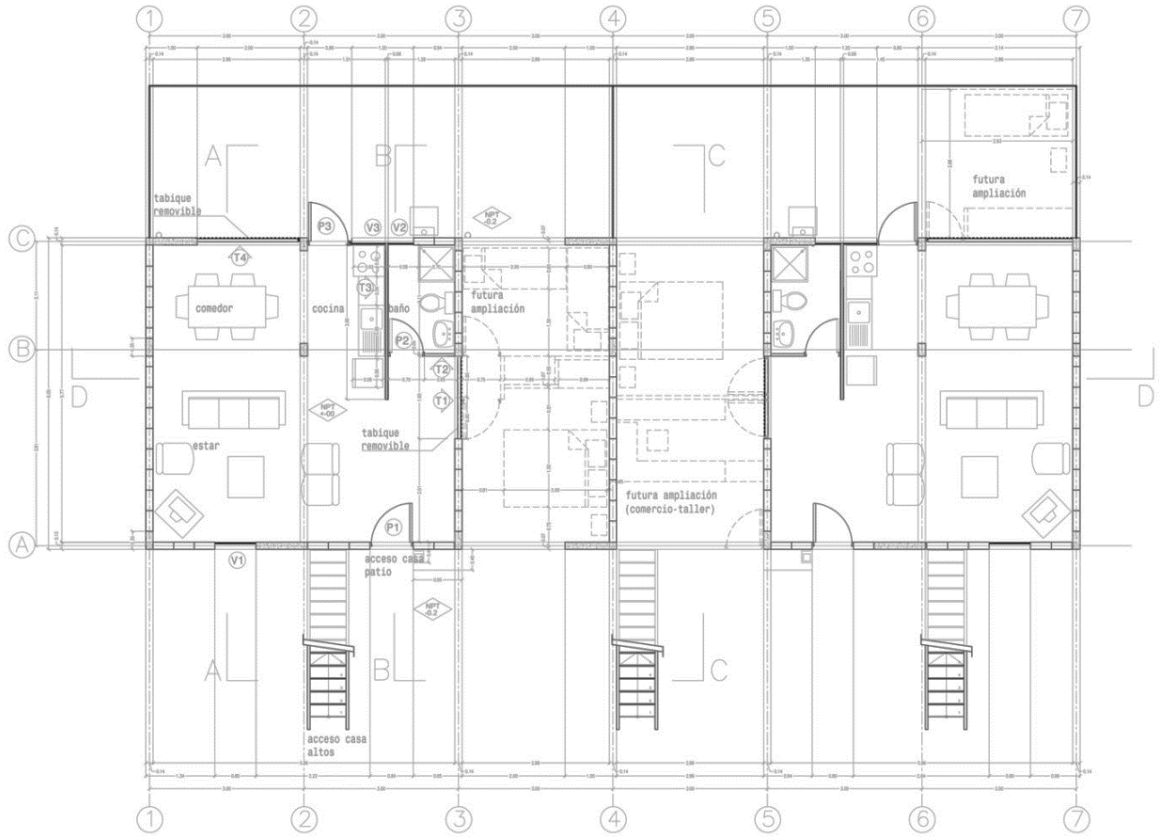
Projeto de arquitetura (planta baixa do 1º pavimento) do Quinta Monroy, Chile
